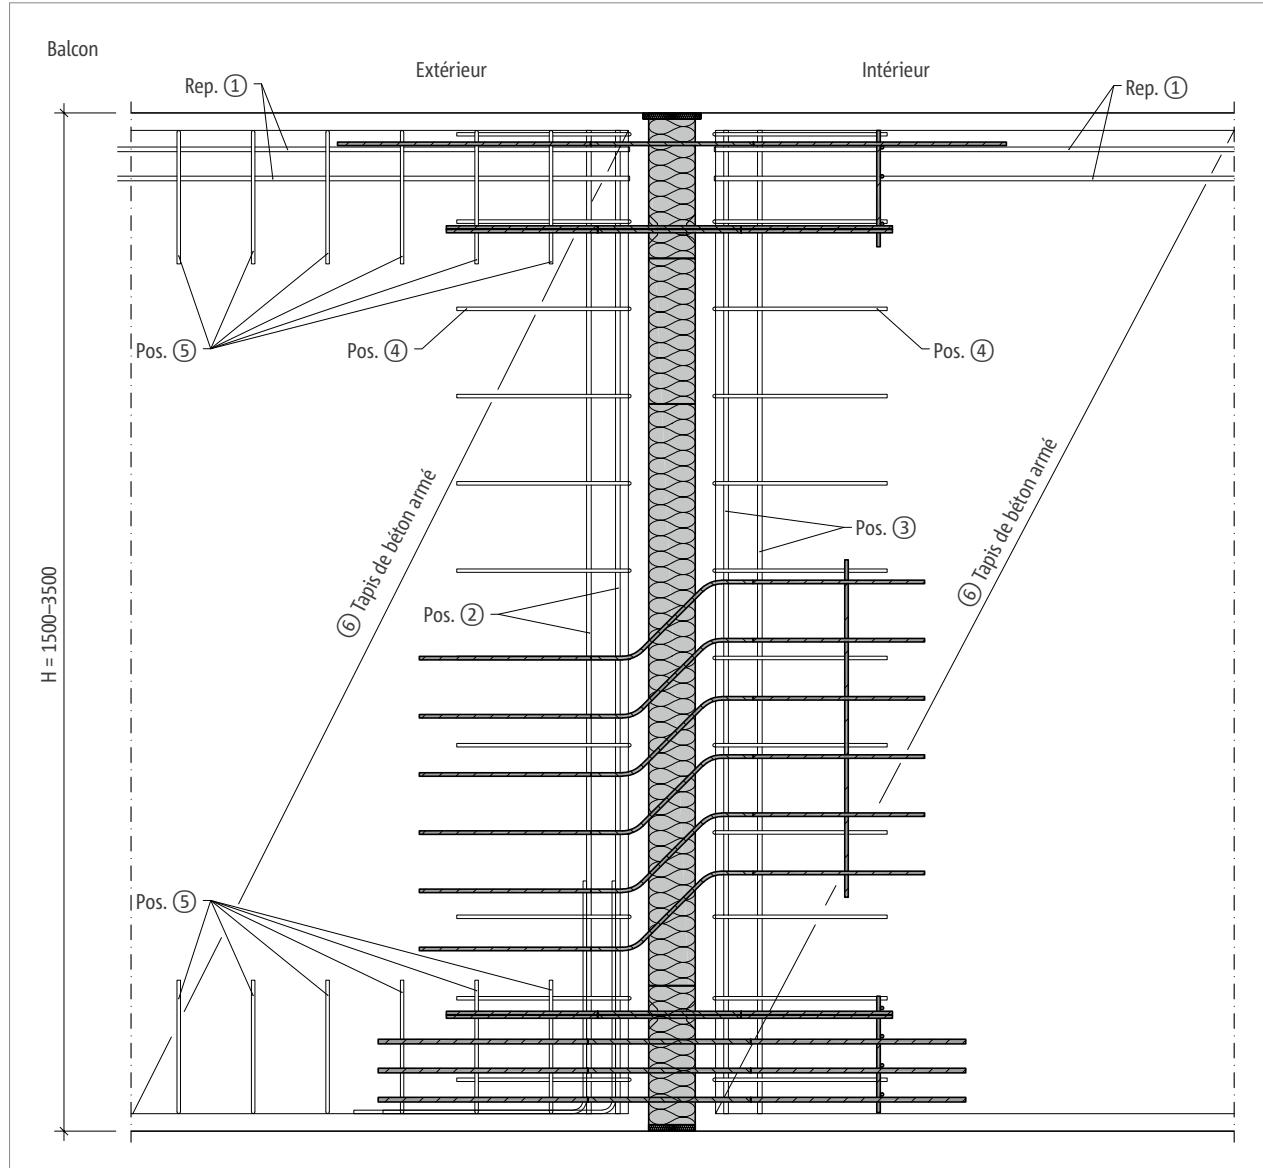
Schöck Isokorb® T type W : Renforcement sur site : coupe
